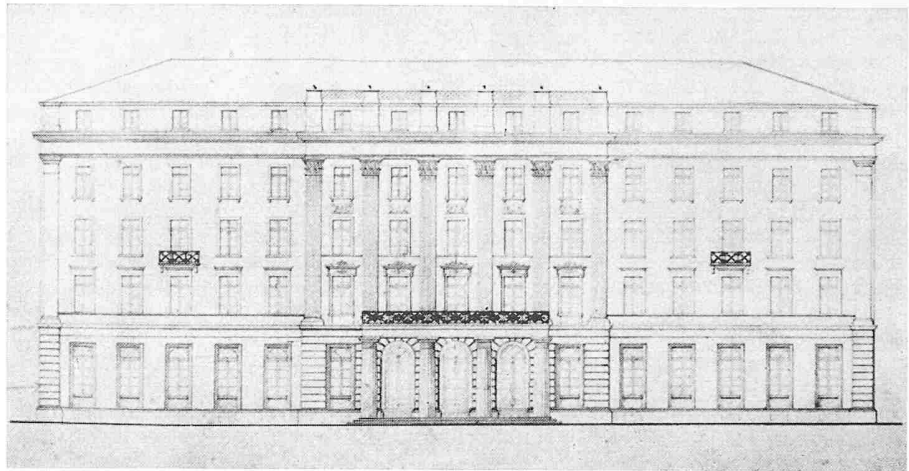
Plan der Schweizerhof-Fassade von Melchior Berry, der mit geringfügigen Abänderungen 1844 zur Ausführung kam
